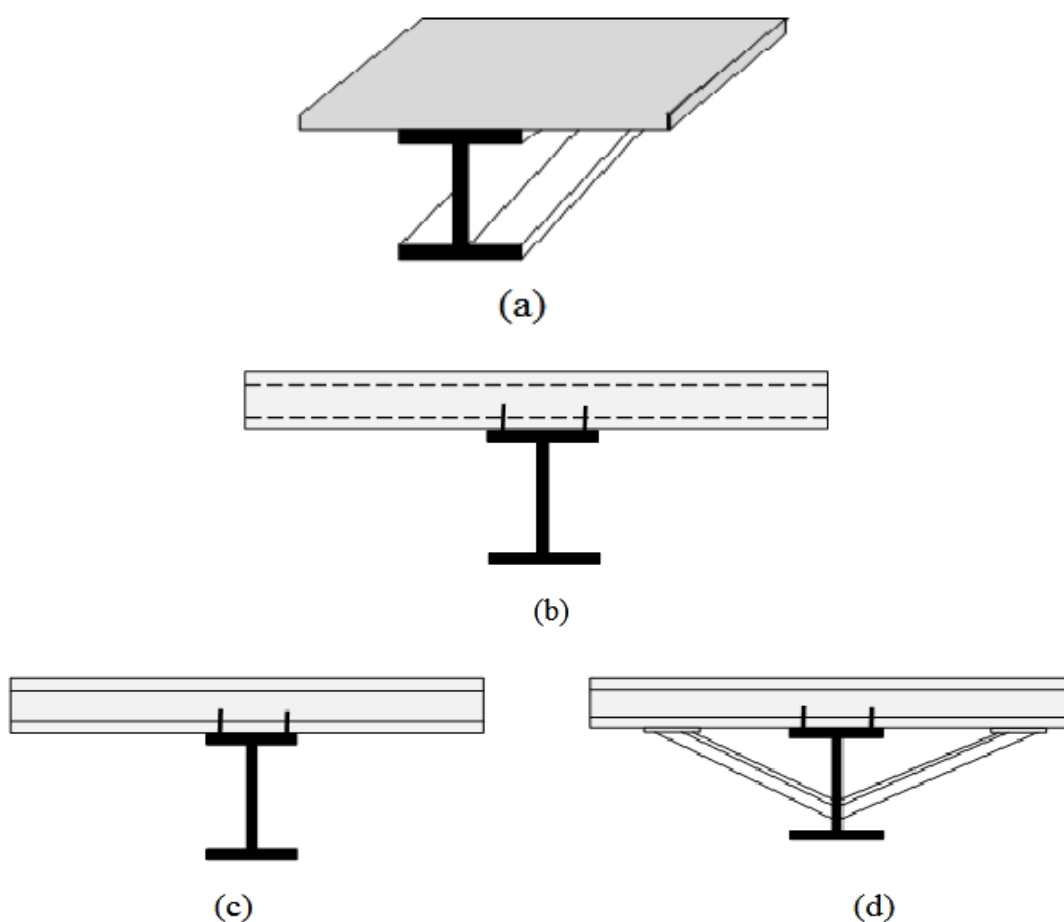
(a) (b) (c) et (d) : Exemples de maintien latéral des sections élancées
